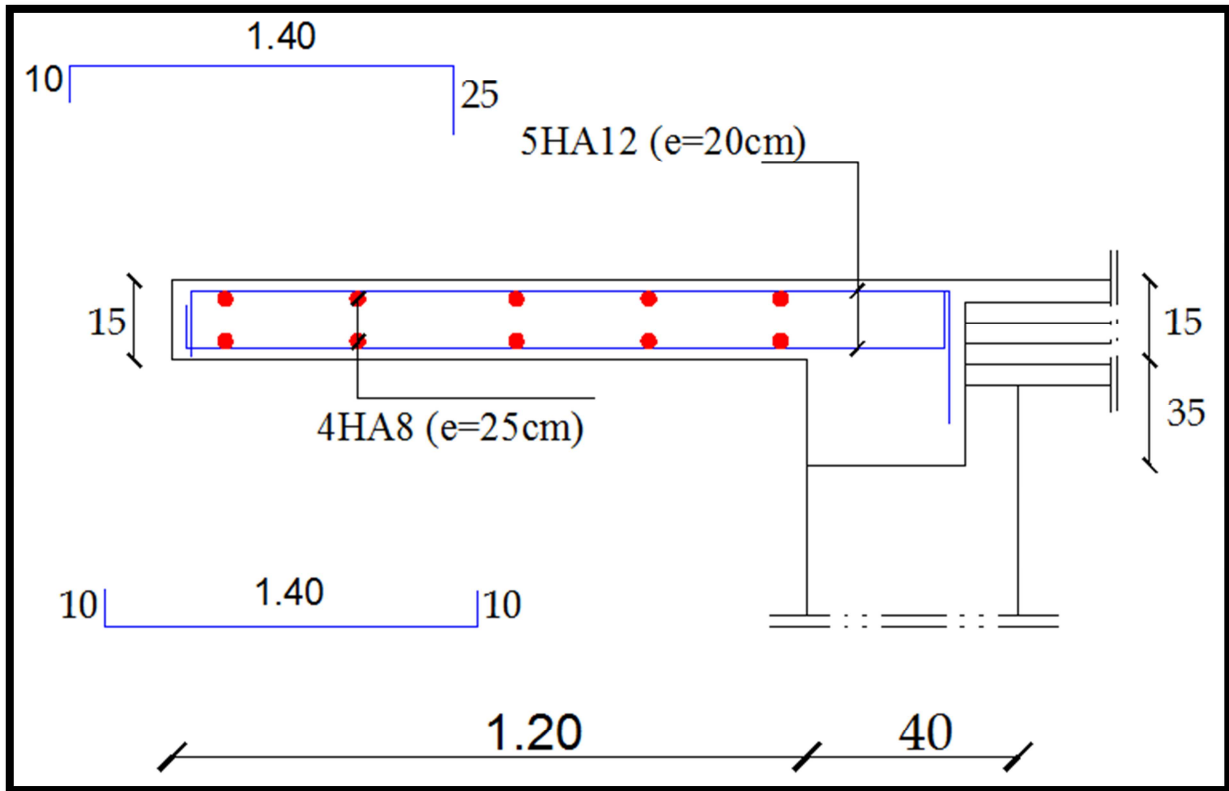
Ferrailage du balcon reposant sur deux appuis
